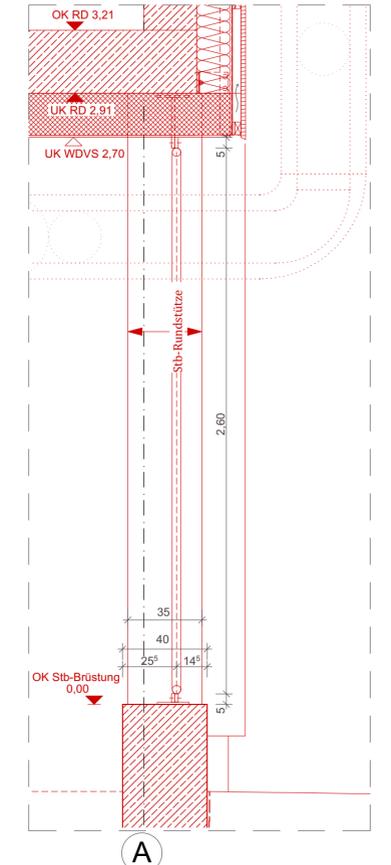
u.4 Anschluss Decke Vertikalschnitt, M 1:10
